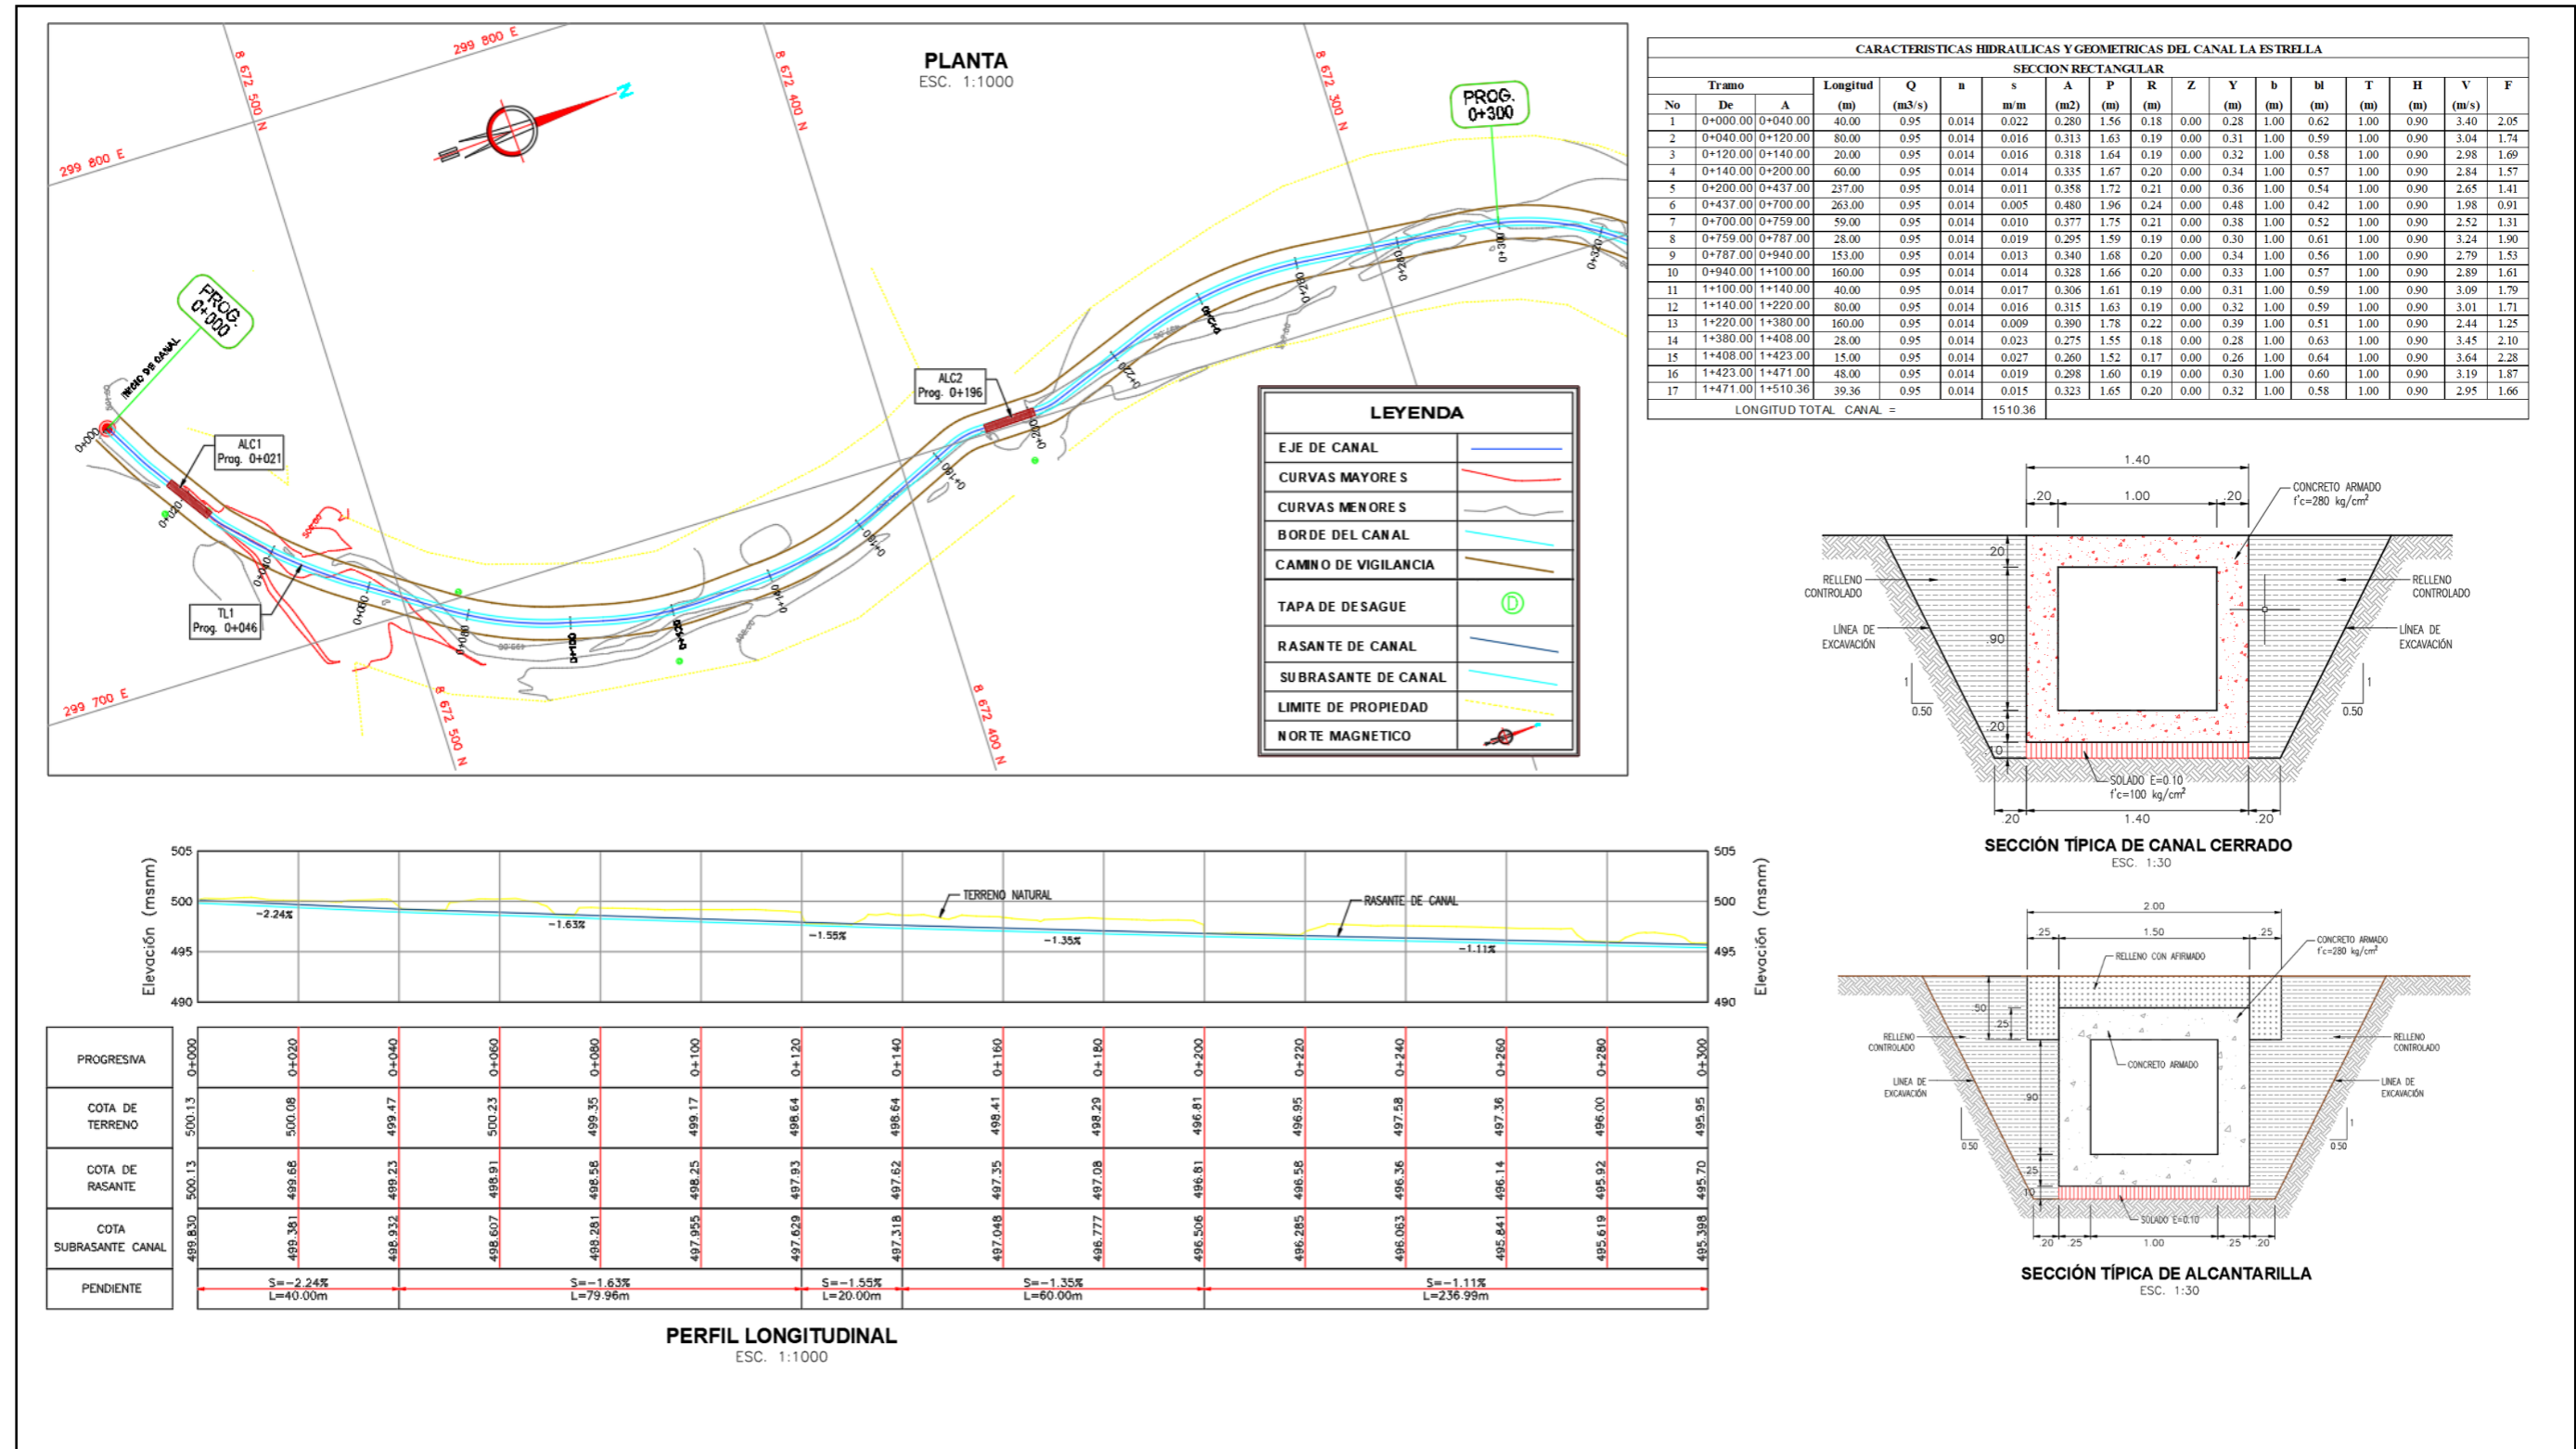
Plano de planta y perfil longitudinal – tramo 0+000.00 – 0+300.00 del canal La Estrella
